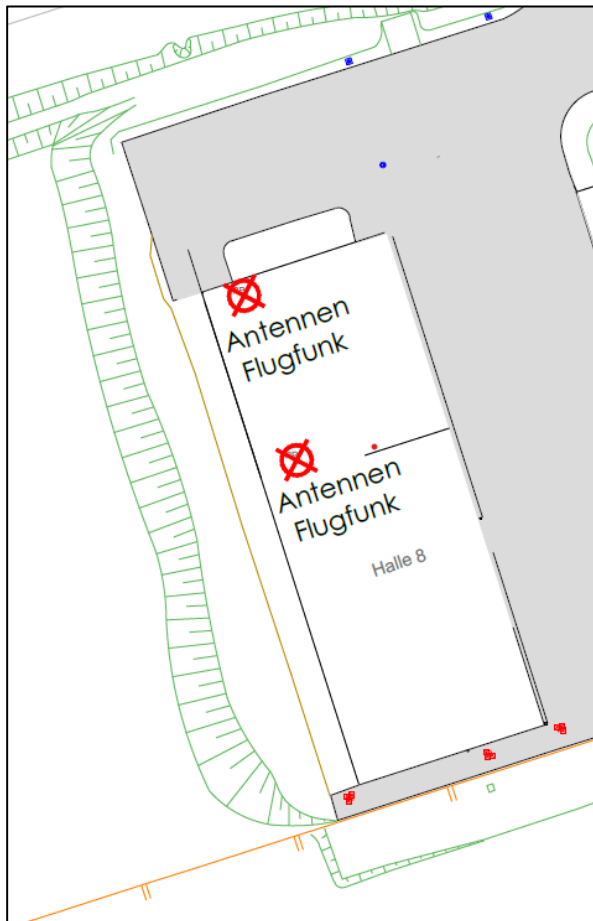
Auszug Lageplan Flughafen, betroffene Flugfunksendeanlage Halle 8 mit Masten der Flugfunksendeanlagen
